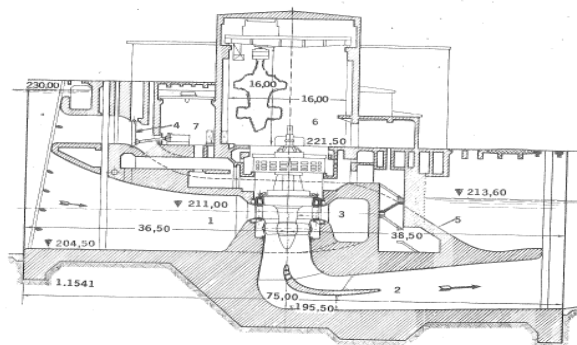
Sección transversal de una instalación de turbina Kaplan.
